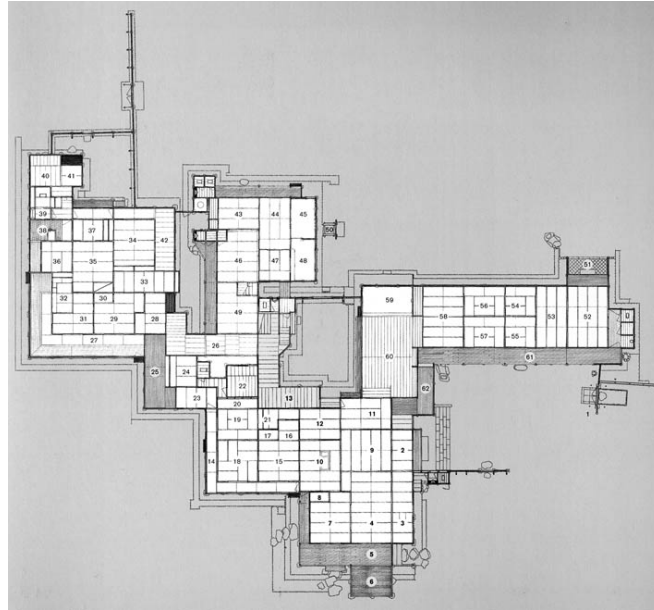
Villa Imperial Katsura. Kyoto, 1615. Planta de los *shoin
